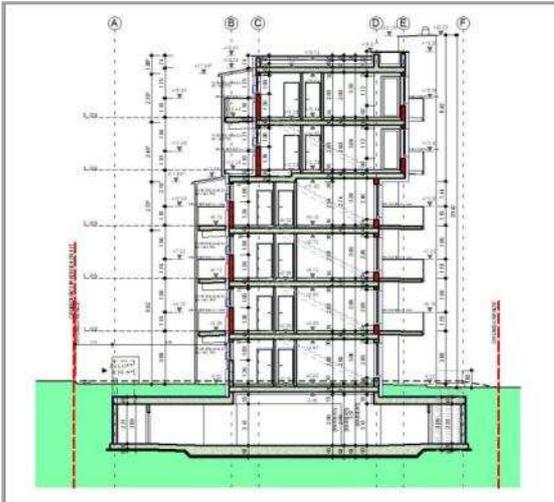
Einreichplan – Querschnitt Schnitt B-B ²⁵³
